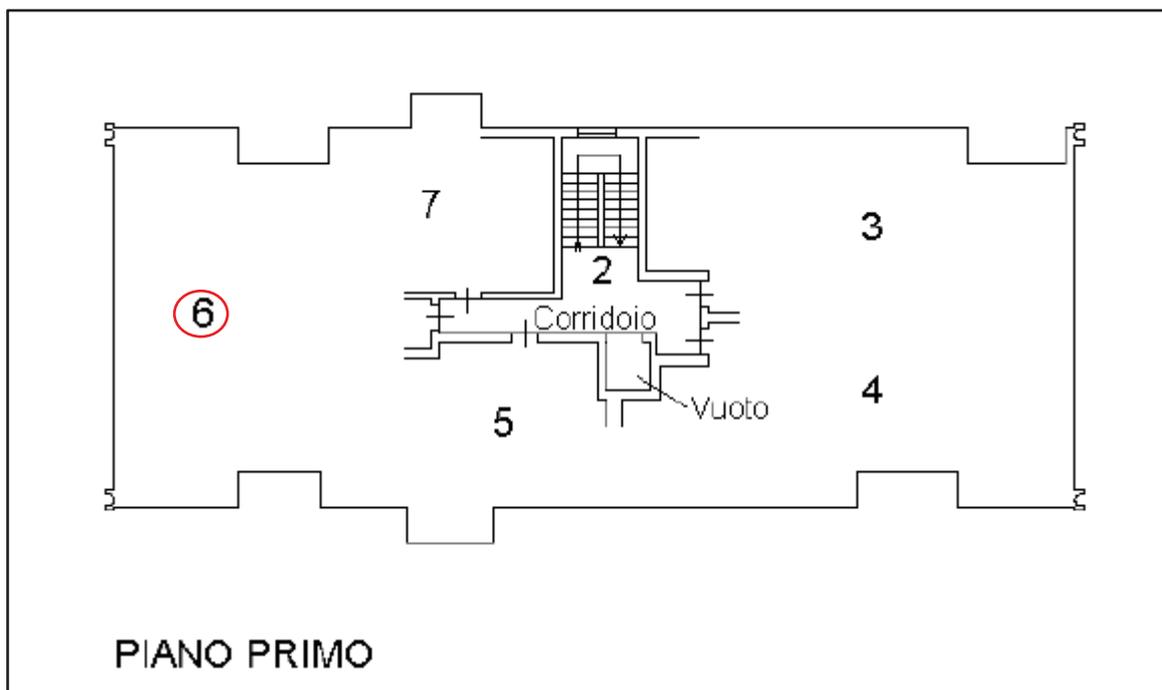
Pianta primo piano tratta dall'elaborato planimetrico
